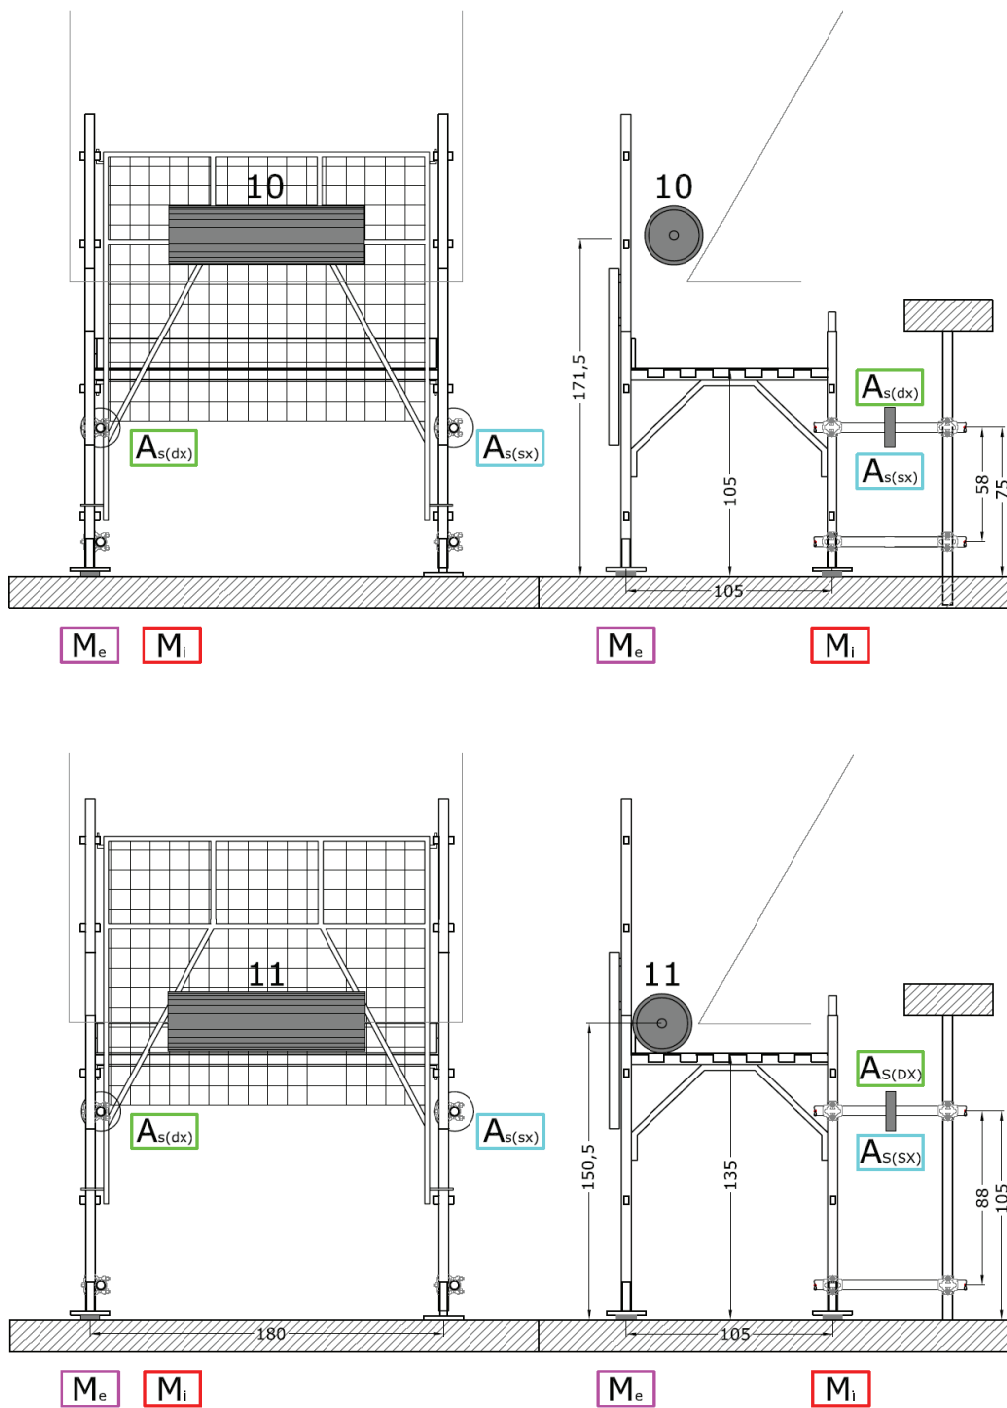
1 Prove d'impatto con rullo cilindrico su protezione continua – Schema CSR – Posizione degli strumenti di misura
